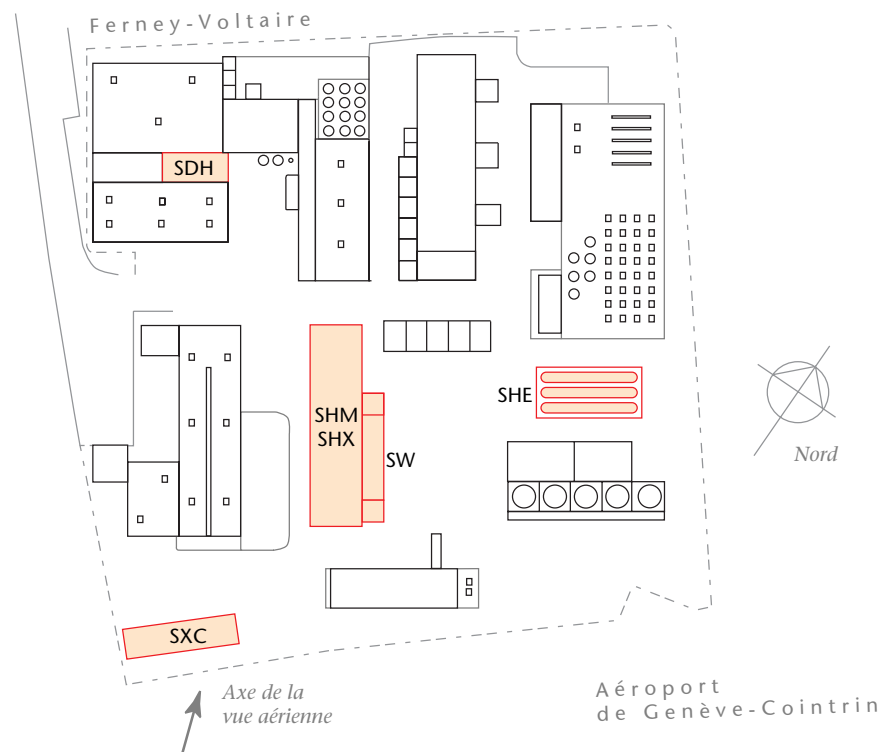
Plan de masse des ouvrages de surface au Point 8
